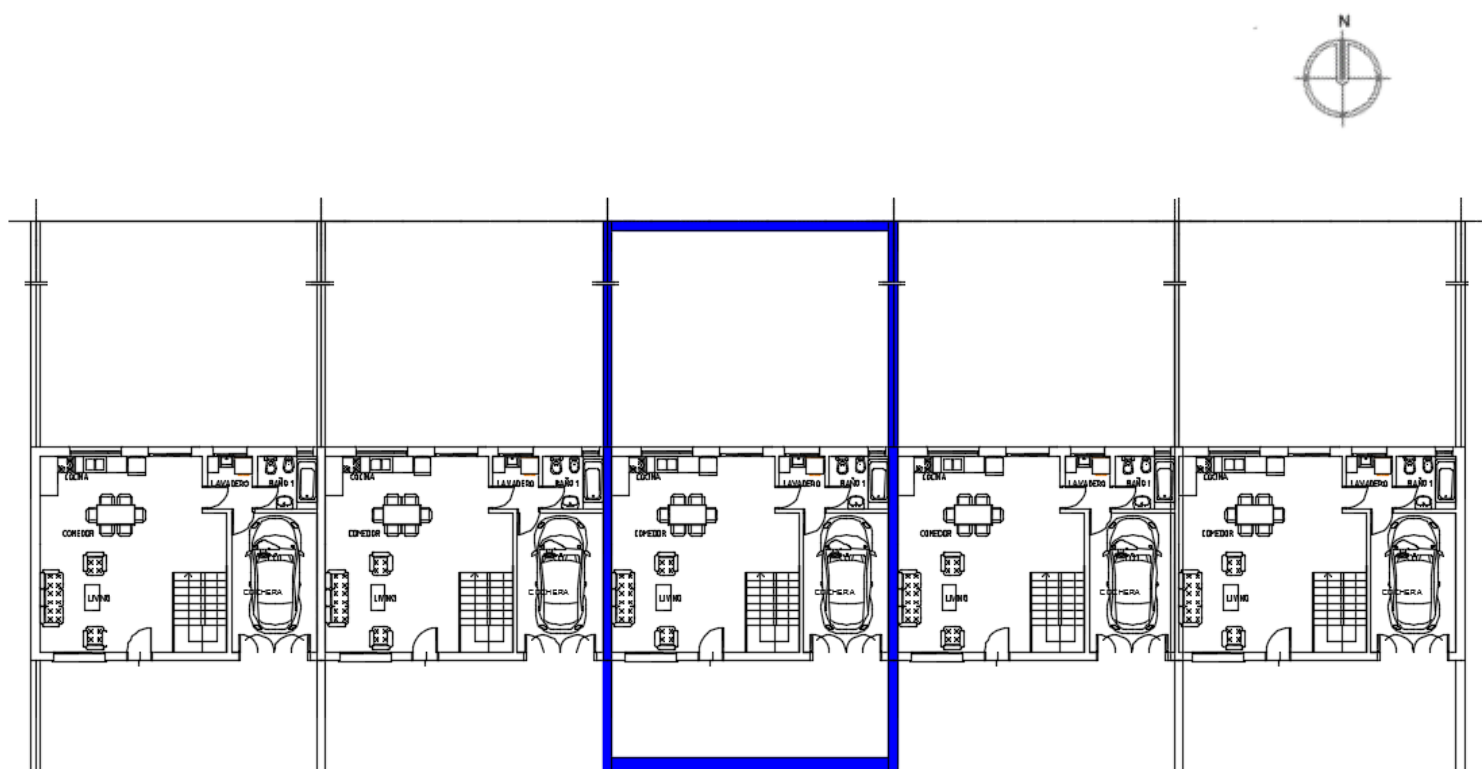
Plano de la planta baja y viviendas colindantes.
